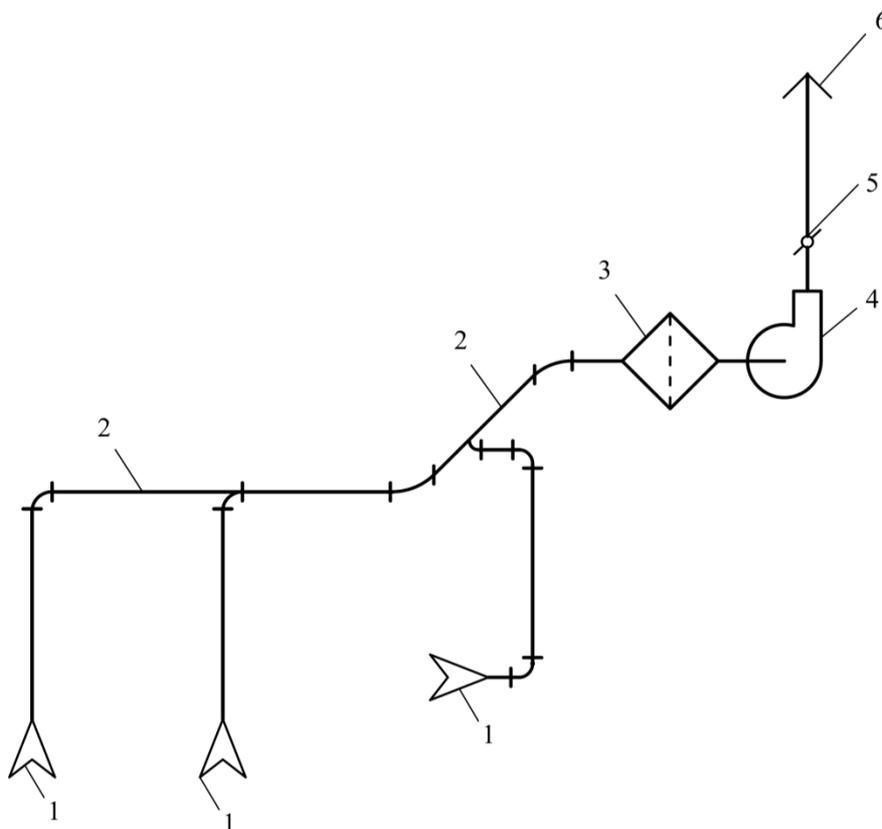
Схема местной вытяжной вентиляционной системы: 1 – местные отсосы; 2 – воздуховоды; 3 – пылеуловитель; 4 – вентилятор; 5 – дроссель-клапан; 6 – факельный выброс
